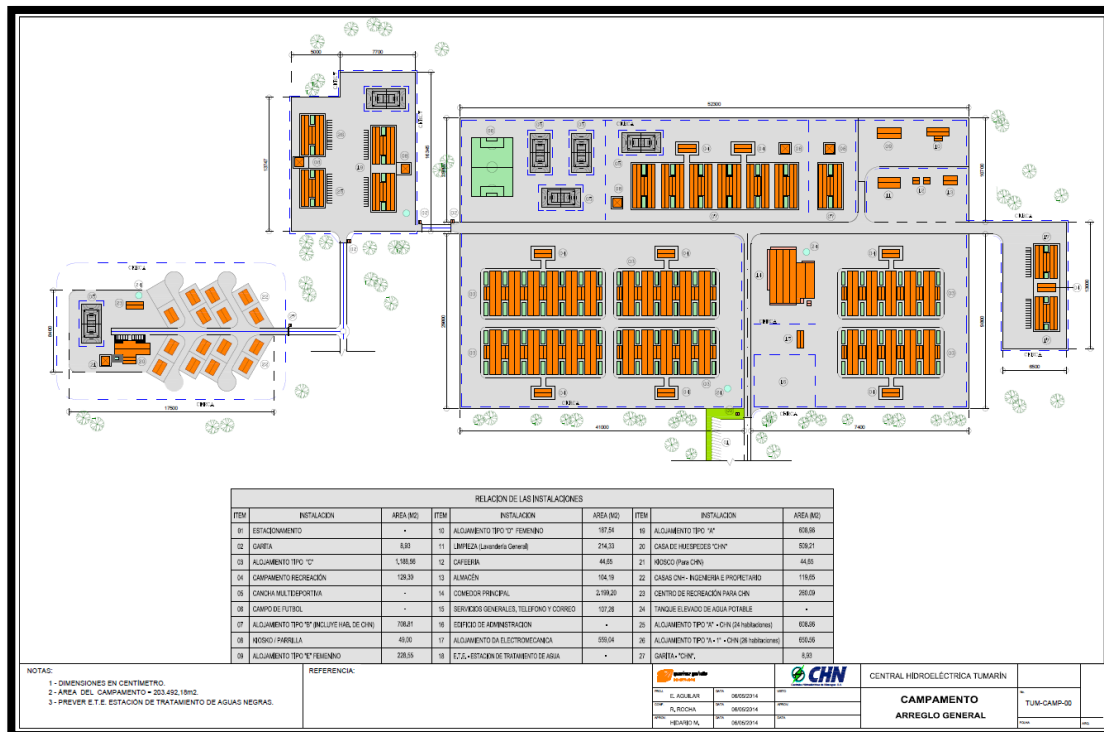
Planta de conjunto de campamentos Tumarín. Fuente: CHN (2014).
